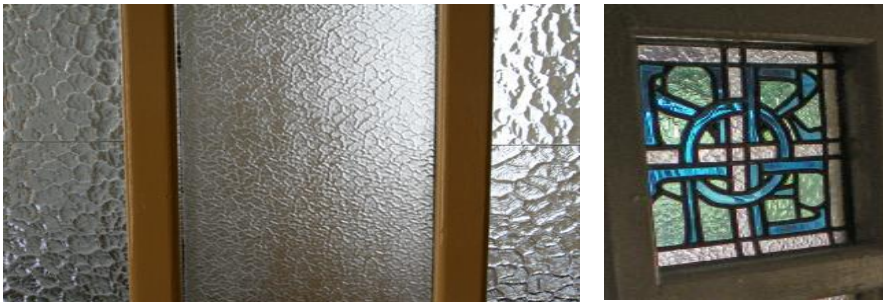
y 432.- Detalle vidrio carpinterías interiores y recuadro decorativo. Zona acceso planta primera. Torreón izquierdo. (A. Propio 2007-2011).
